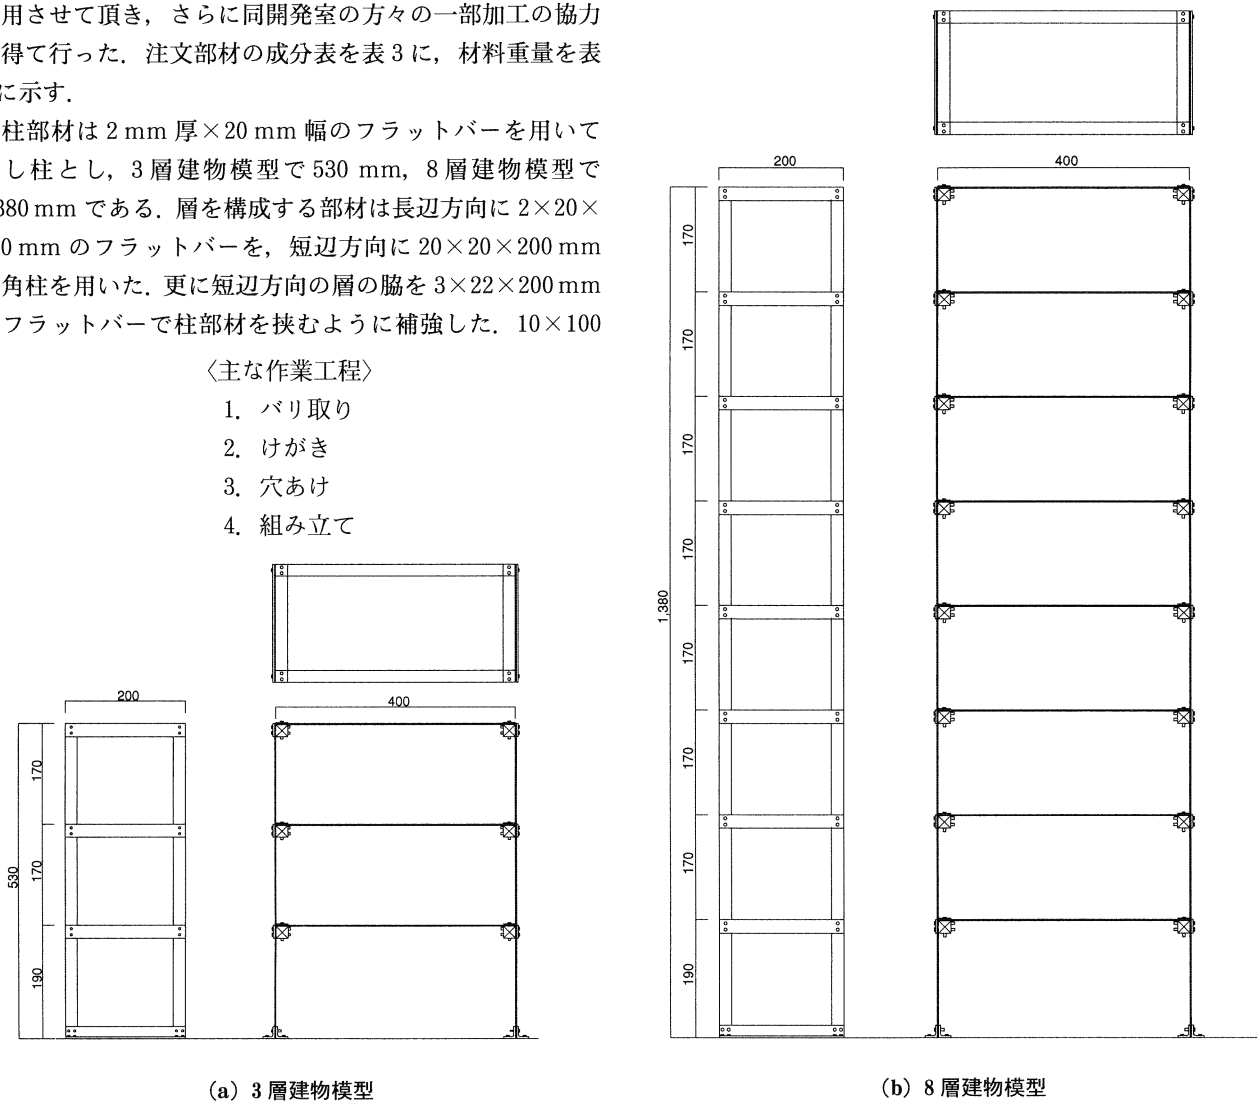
多層建物骨組みモデル立面図 (単位: mm)
